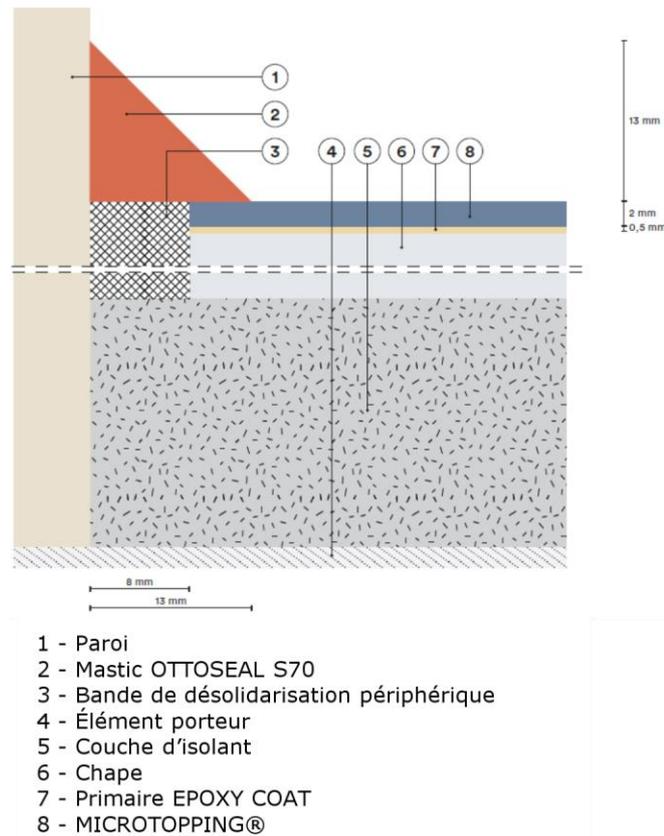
Traitement des rives sur chape flottante en locaux classés E1 (sans plinthe)
